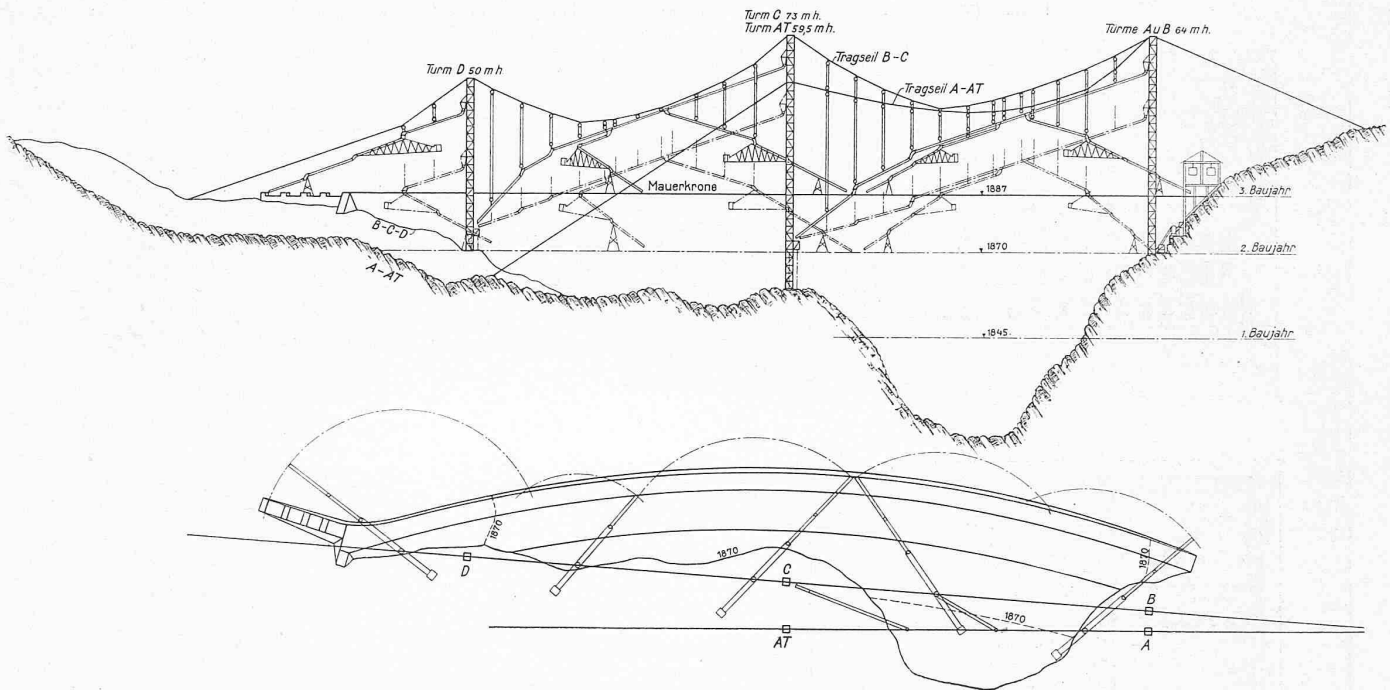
Grundriss und Ansicht im Vollausbau, für Betonierung bis auf Stauwandkrone auf 1887 m ü. M. — Masstab 1:2000.
